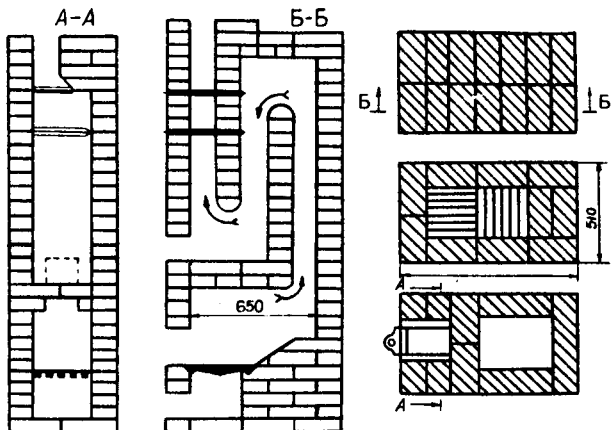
Боковой и горизонтальные разрезы печи (сверху вниз): основание; 6-й ряд с установкой колосниковой решетки; 26-й ряд с установкой задвижки
